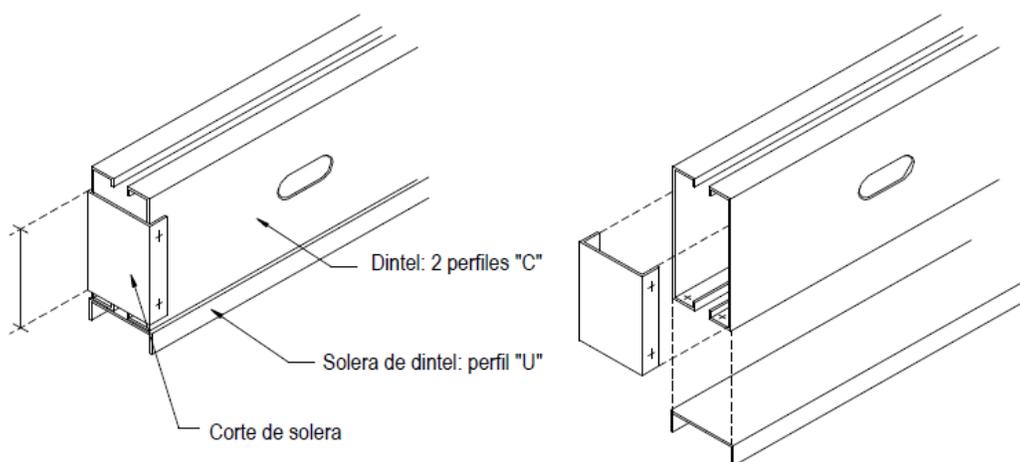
Detalles de piezas prearmadas para dinteles.
